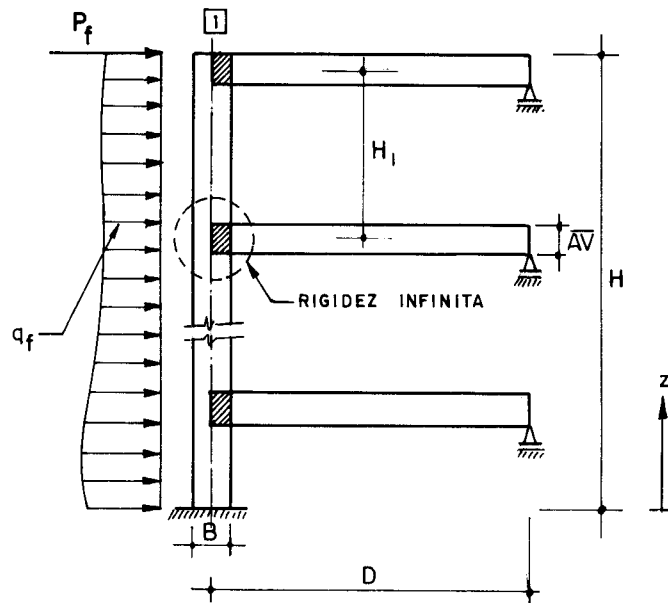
Pannel com um pilar de p \tilde{o} rtico e vigas simplesmente apoiadas na outra extremidade
